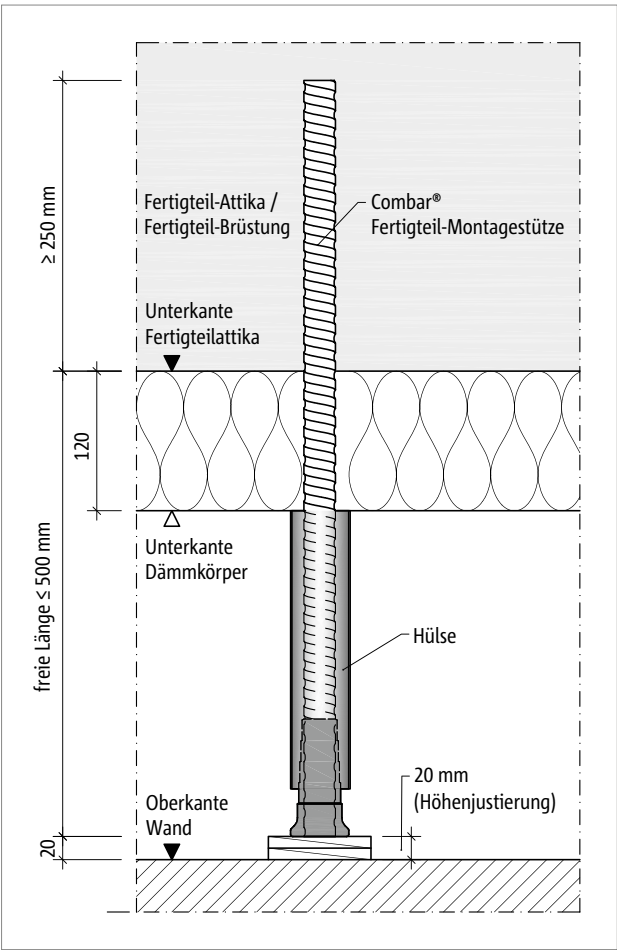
Schöck Combar® Fertigteil-Montagestütze: Planungsmaße
